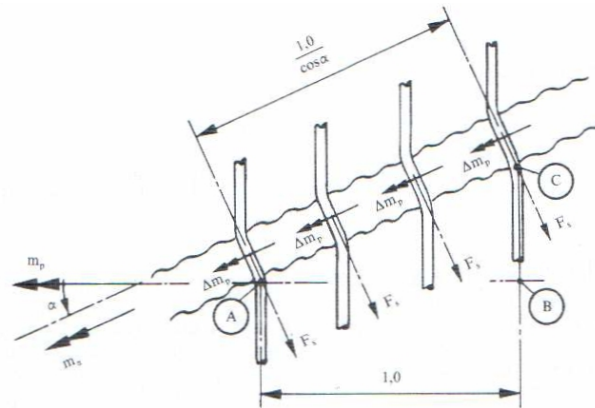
Efectul de deviere a barelor după Wood [23]
